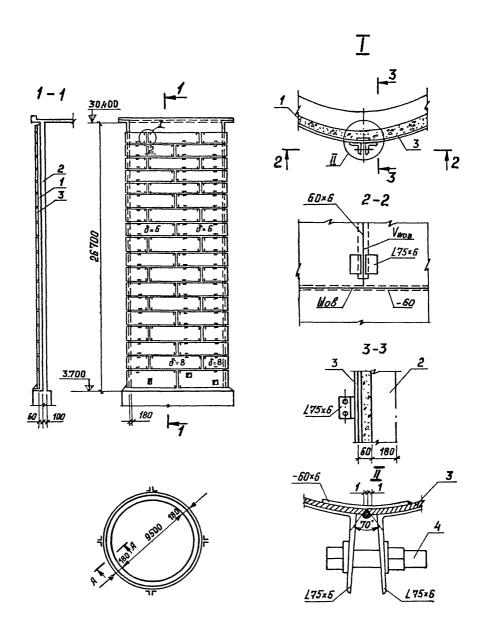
Усиление железобетонного силоса стальной обоймой
